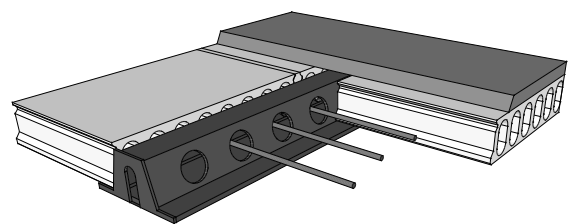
Konstruktionsschema Slim-Floor Decke mit Hohldeckenelementen
